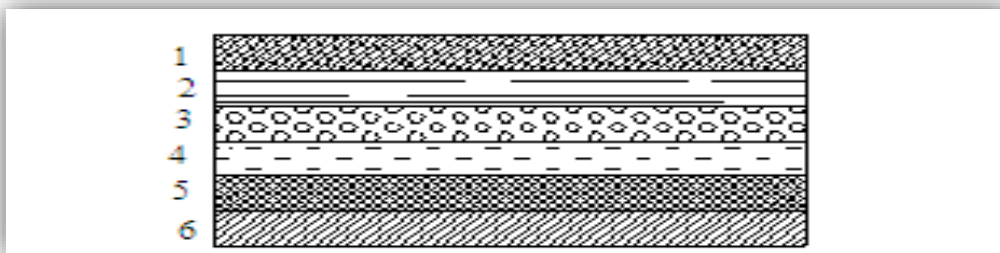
Coupe verticale du plancher terrasse à dalle pleine.
